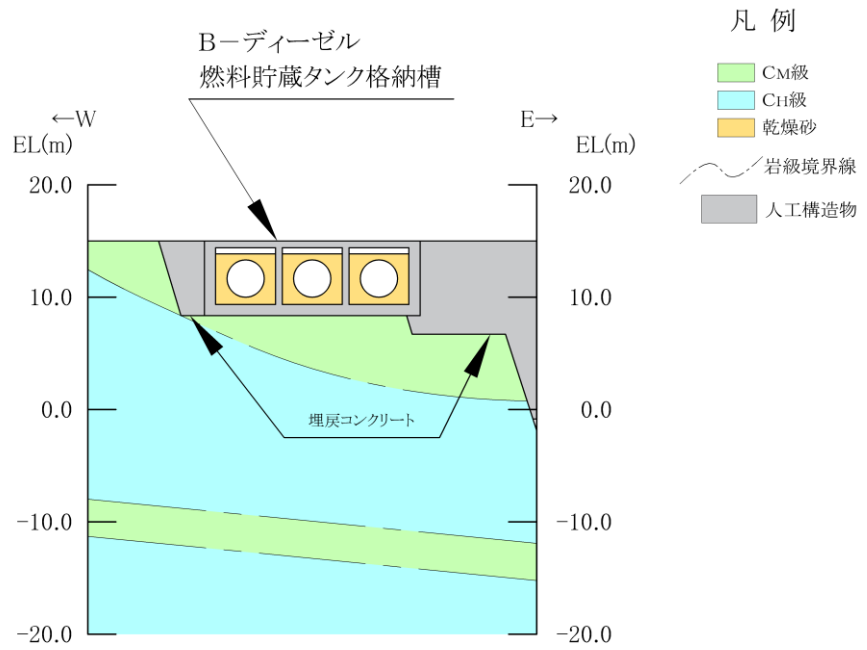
B-ディーゼル燃料貯蔵タンク格納槽 評価対象地質断面図 (A-A 断面)
